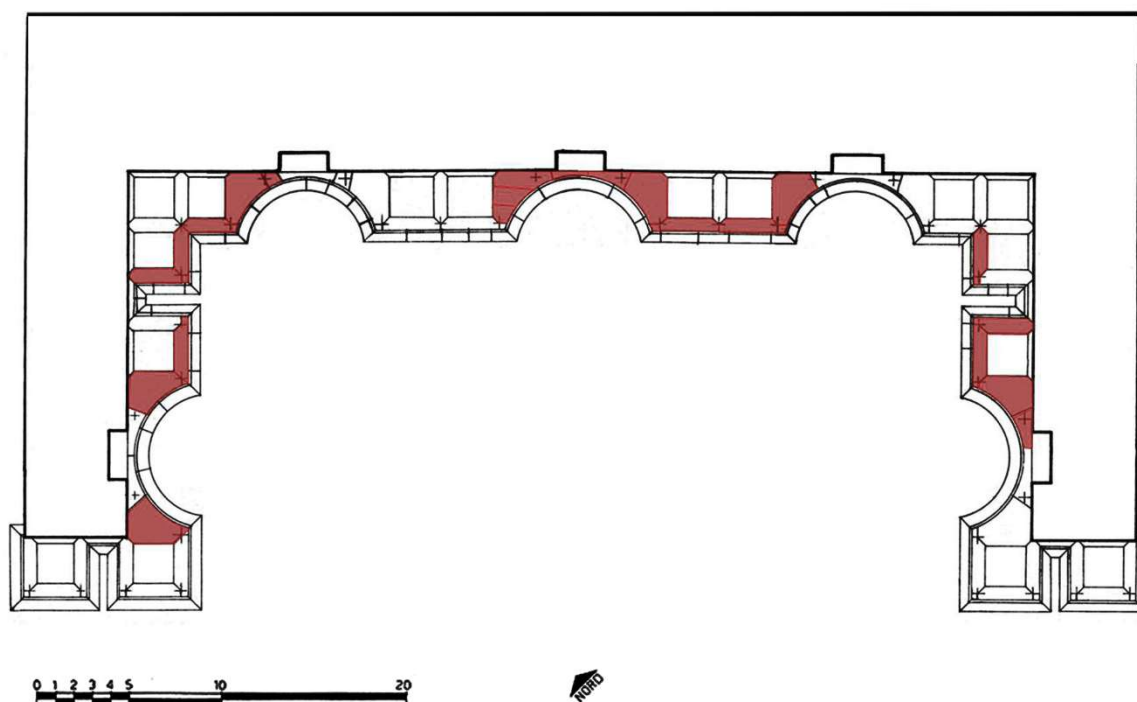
, planimetria con il posizionamento degli architravi, elaborazione di D. De Bernardi Ferrero (Da Archivio MAIER).
